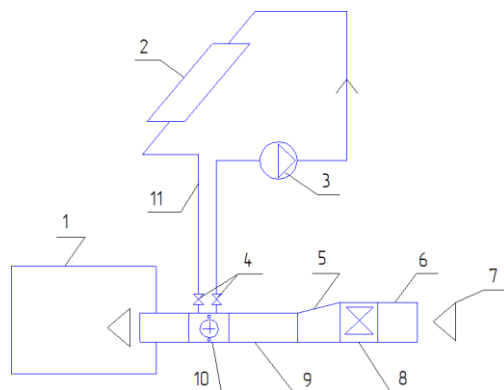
Схема системы гелиовоздушного отопления: 1 – модель отапливаемого помещения; 2 – солнечный коллектор; 3 – циркуляционный насос; 4 – запорная арматура; 5 – переход на прямоугольный воздуховод; 6 – круглый воздуховод; 7 – вход наружного (холодного) воздуха; 8 – канальный осевой вентилятор; 9 – прямоугольный воздуховод; 10 – воздушонагреватель жидкостной; 11 – трубопровод
